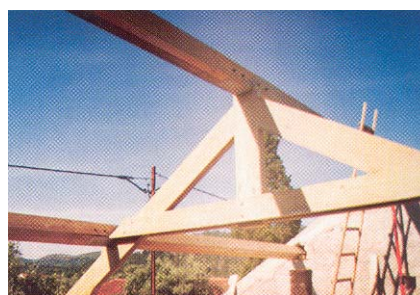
Asnas de madeira – aproveitamento arquitectónico com estrutura à vista em acções de reconstrução e reabilitação
